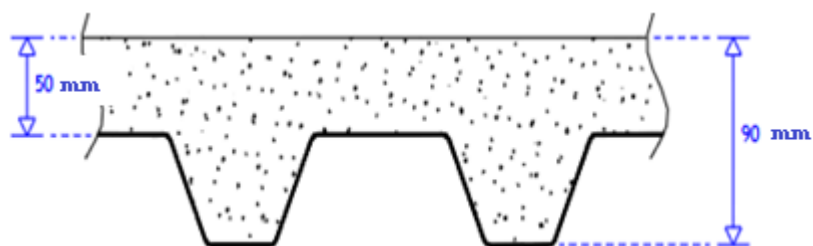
Espessuras mínimas [mm] da secção transversal de uma laje que faz parte de uma viga mista ou que é utilizada como diafragma
